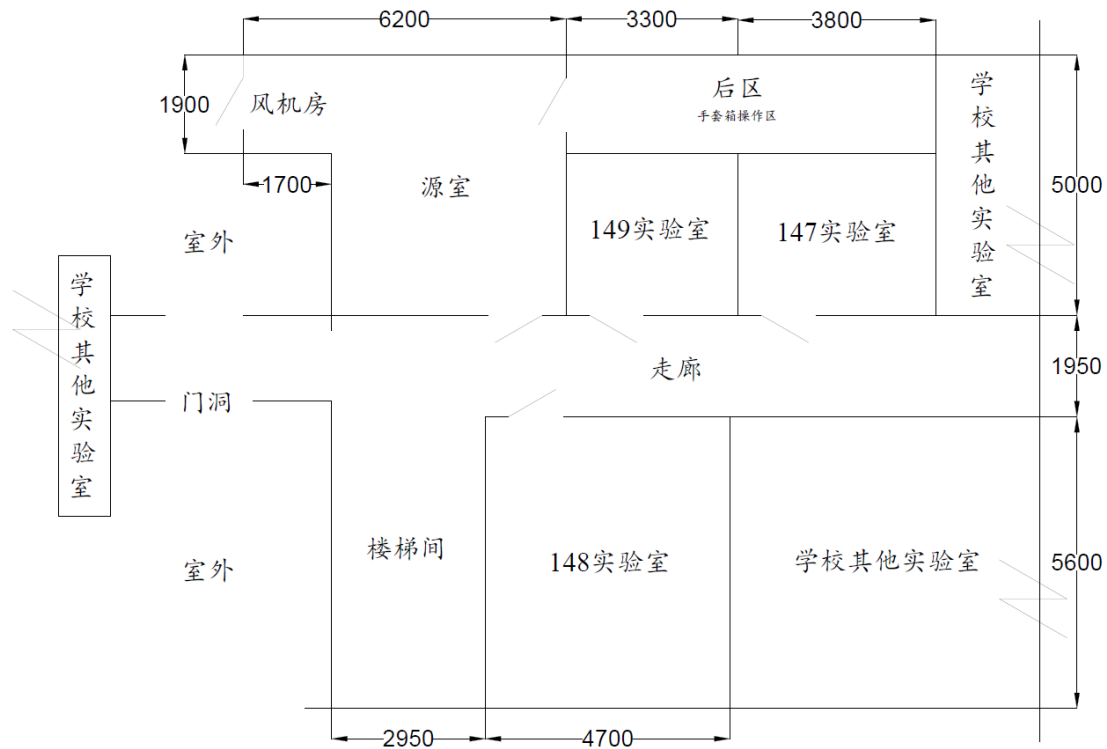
环科楼拟退役实验室平面布置图 (mm)
